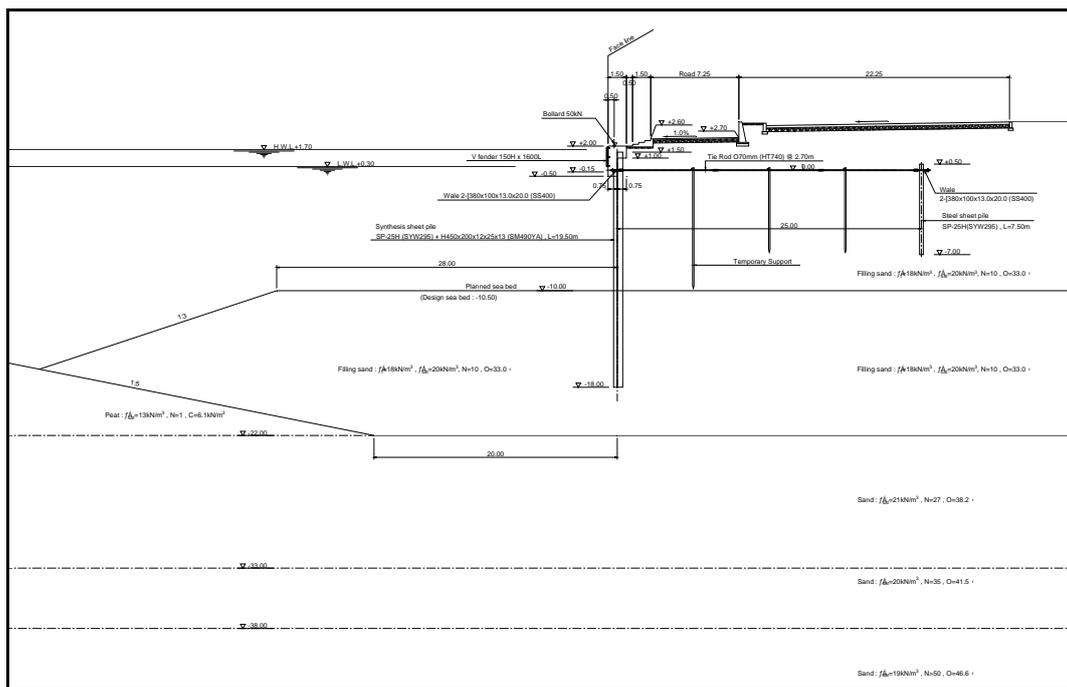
標準断面図 -10m 岸壁 (パイロットボート岸壁 No. 2)
